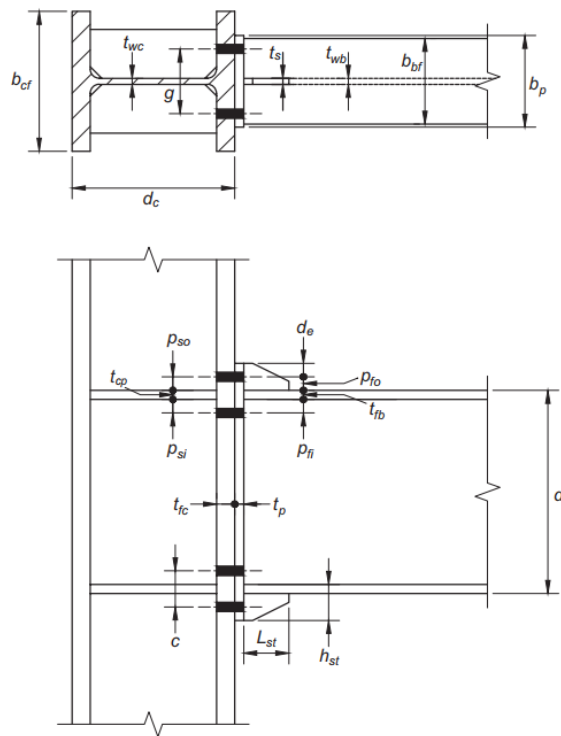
Geometría y parámetros para conexión de momento con plancha extrema atiesada 4ES. Fuente: ANSI/AISC 358-22.
